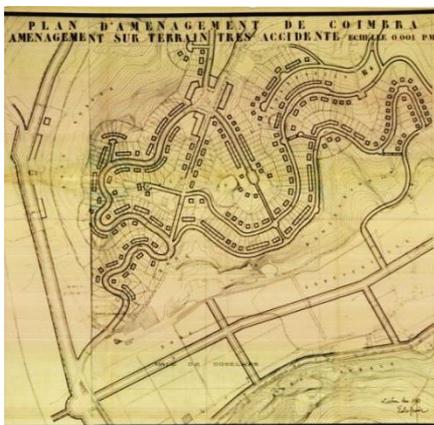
Planta da Zonas, representação de terreno irregular.
